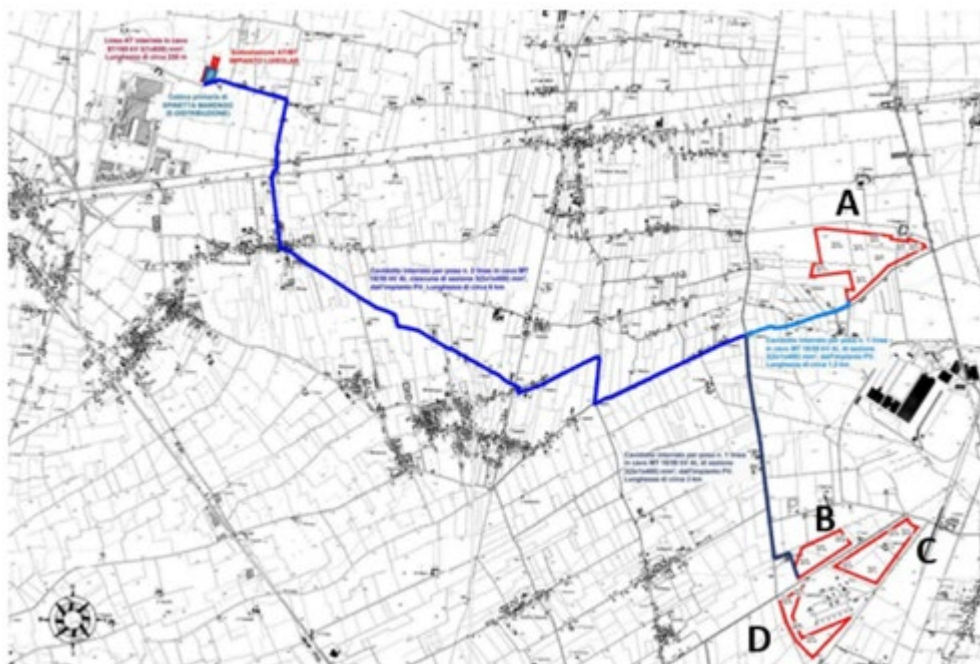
Inquadramento su carta dell'impianto (rosso), il cavidotto celeste (1,2km) dall'impianto A all'intersezione, il cavidotto nero (3km) dall'impianti B, C e D fino all'intersezione, il cavidotto di collegamento blu (9km) dall'intersezione fino alla SE.
